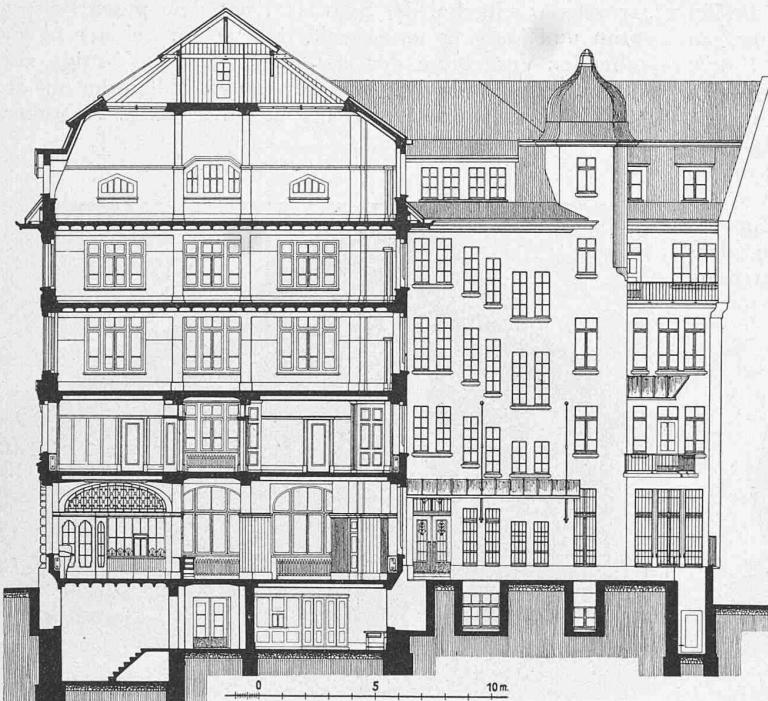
Schnitt senkrecht zur Brandschenkestrasse, und Hoffassade. — 1 : 250.
